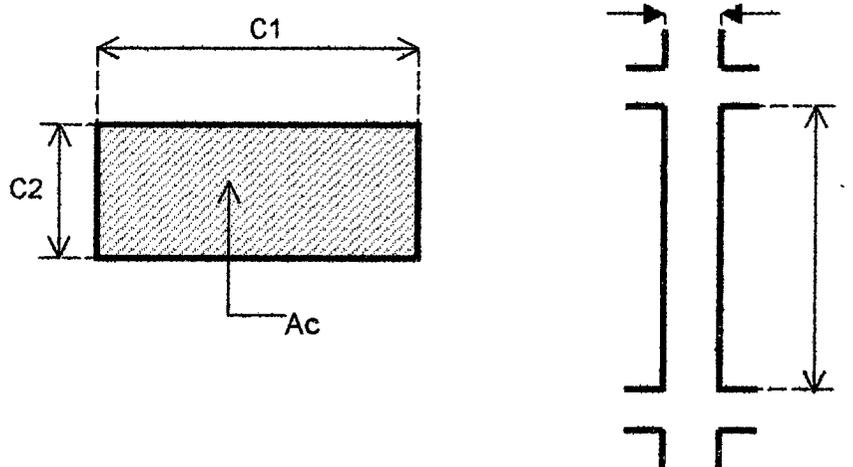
a Requisitos para las dimensiones de columnas.
